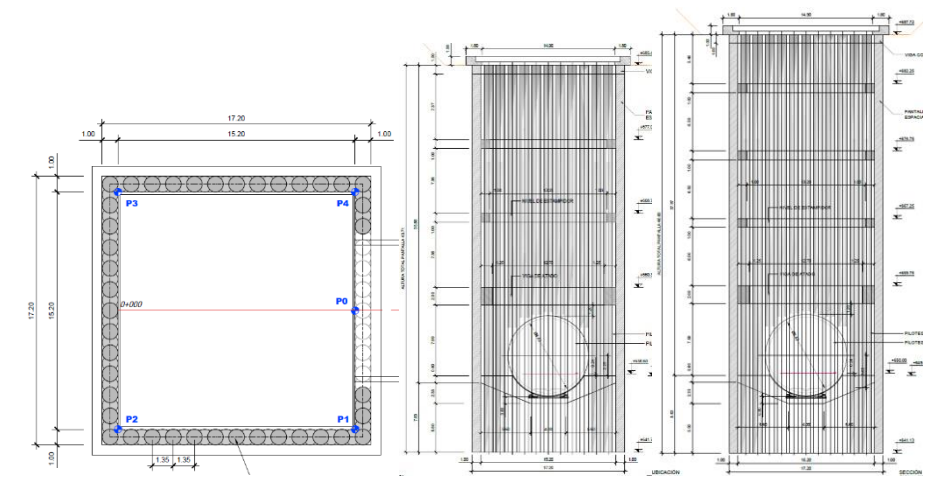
Planta y alzados PET-1 (Alt. 1-2 y 3-4)
